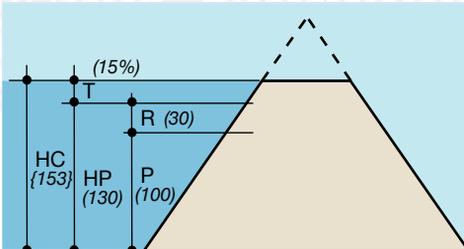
Hauteur de la construction (définitions et exemple dans le texte).
